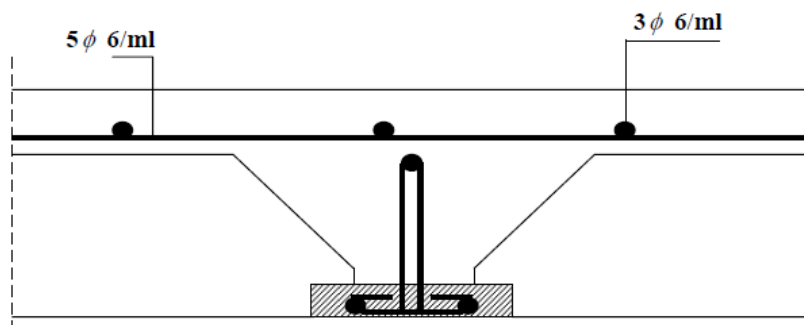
Schéma de ferrailage de la dalle de compression.
